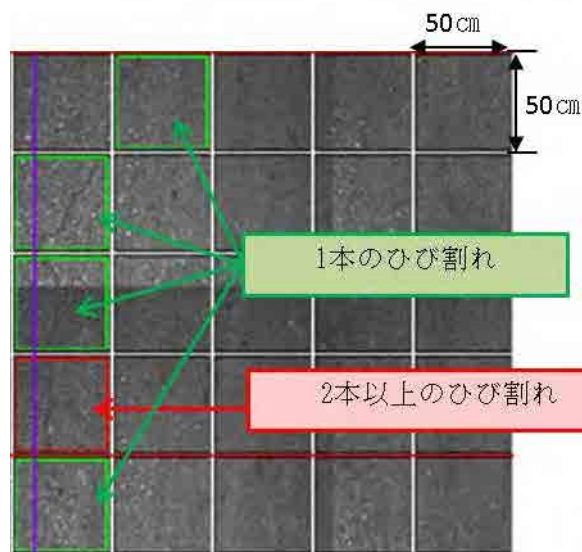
アスファルト舗装におけるひび割れ判読の例
